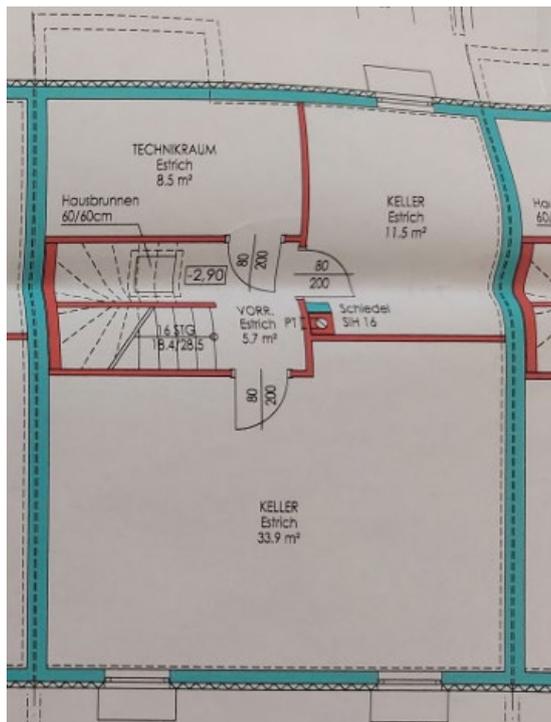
Top 3 - Grundriss KG | Einreichplan | 26.08.2014
